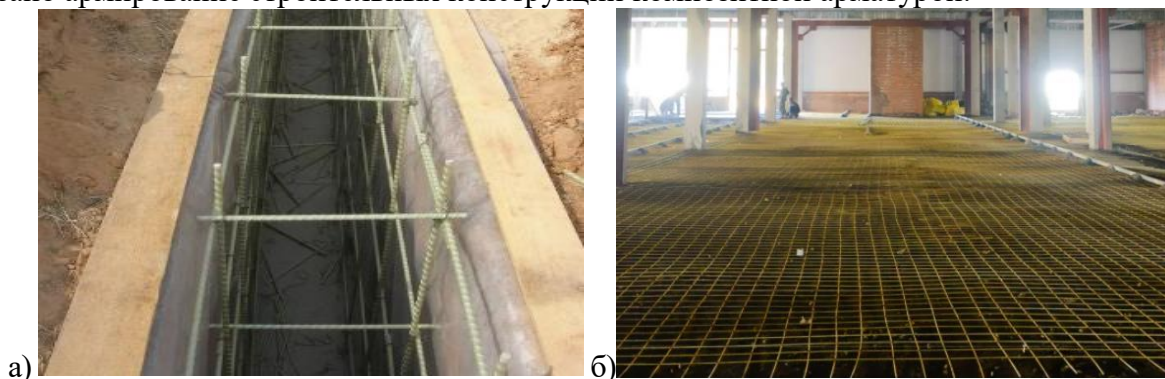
Армирование строительных конструкций композитной арматурой: а) армирование ленточного фундамента; б) армирование плиты перекрытия
